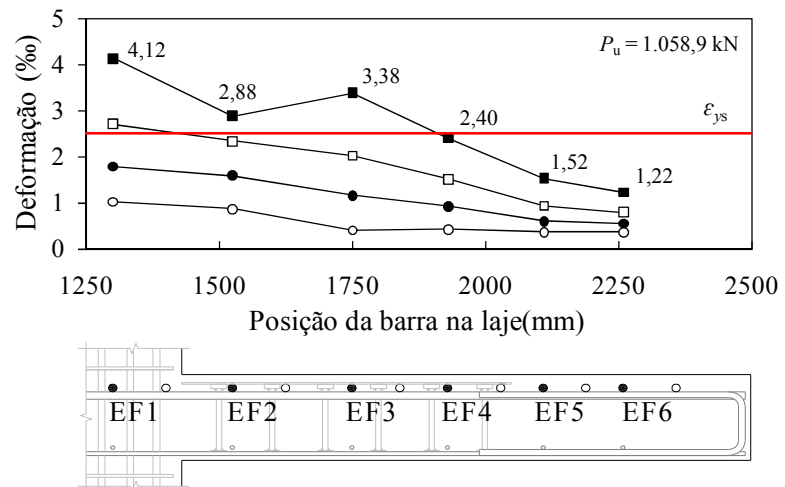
Deformações na armaduras de flexão da laje LC08
